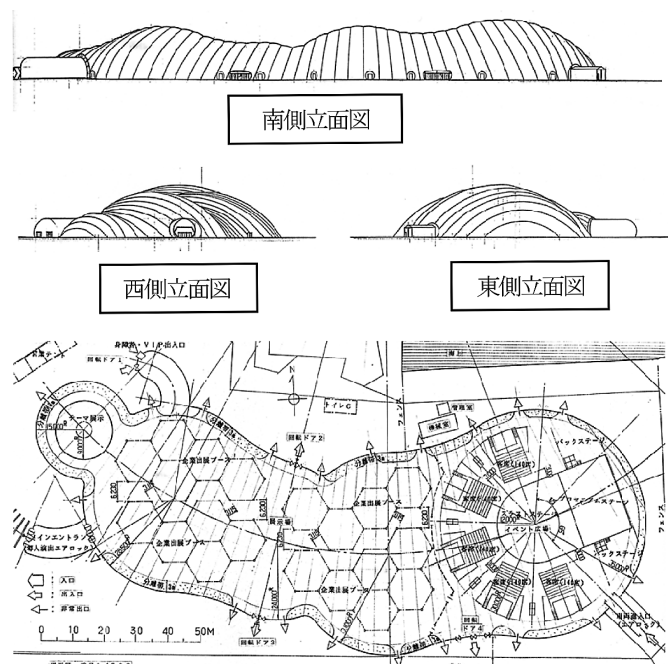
青函博エアドーム 立面図(上), 平面図(下)
